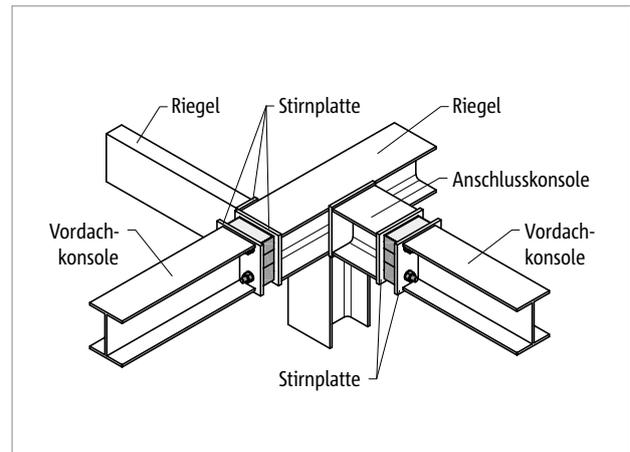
Schöck Isokorb® T Typ S: Außenecke
